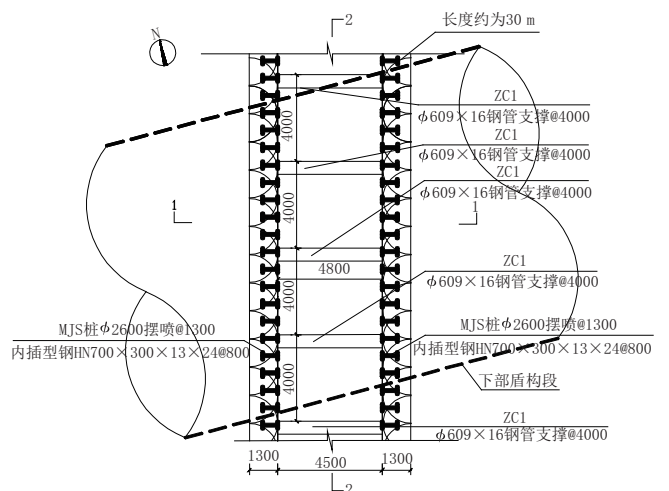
上穿城市地道基坑围护平面布置图(单位:mm)
